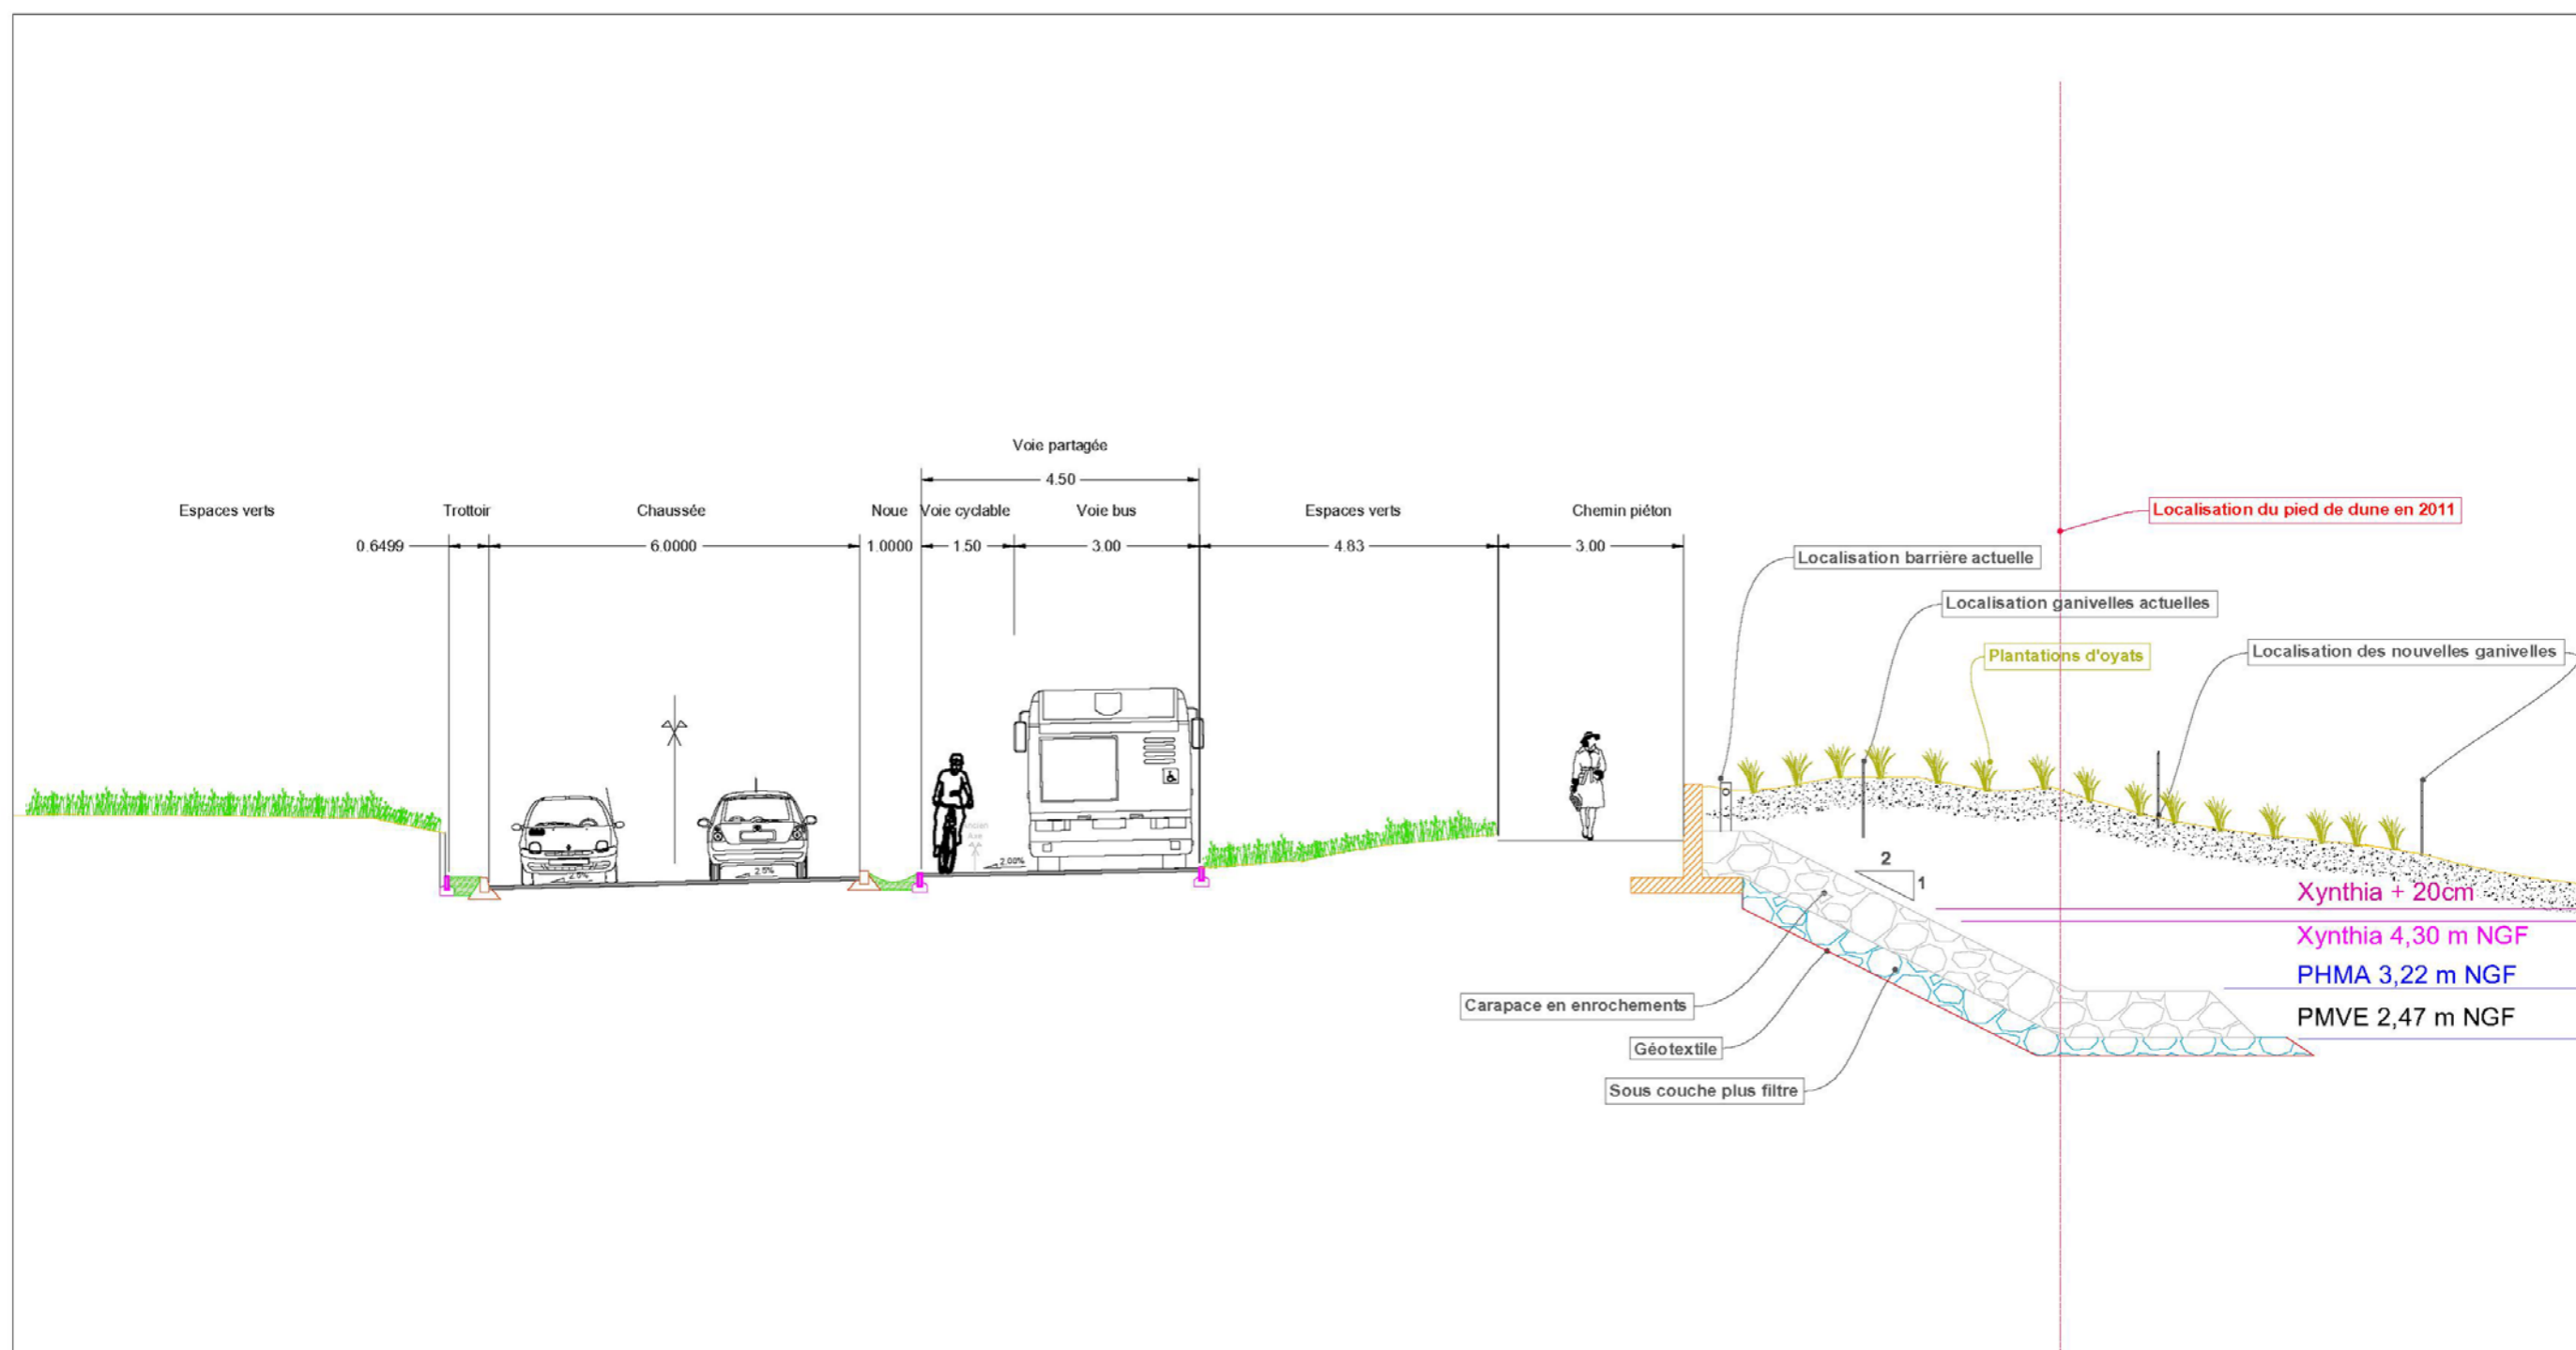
Coupe type de la protection en enrochements enterrée au niveau du virage du Défend (Coupe AA).
